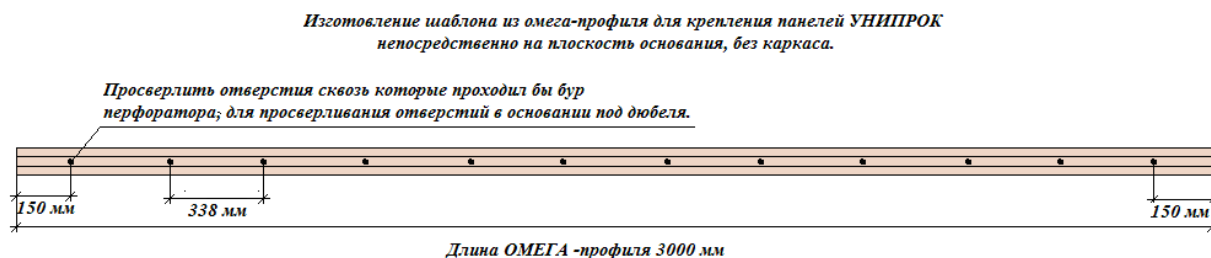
Изготовление шаблона из Омега-профиля для высверливания отверстий в основании
